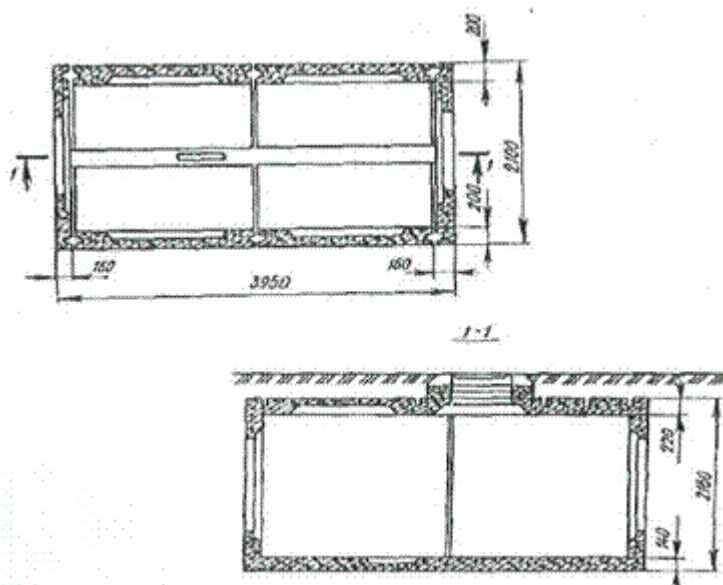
Проходной сборный железобетонный колодец, специального типа ККС-1 на 25-36 каналов трубопровода.
